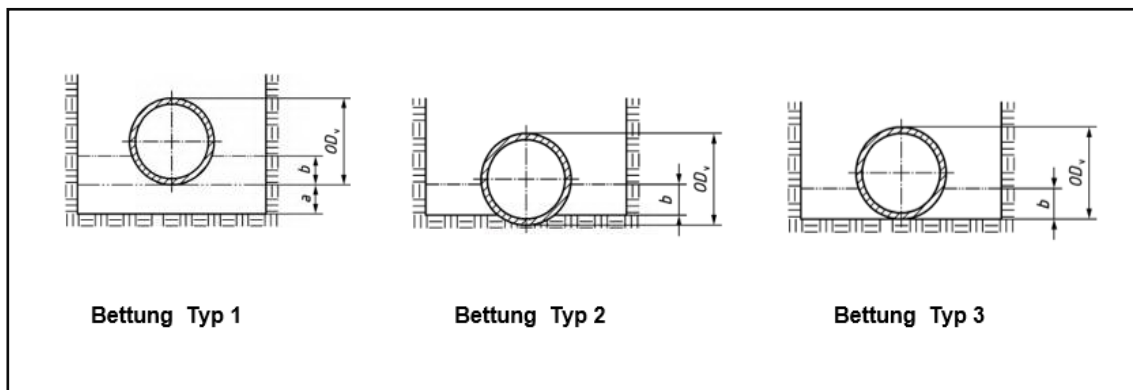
Rohrbettungstypen nach DIN EN 1610 [19]
